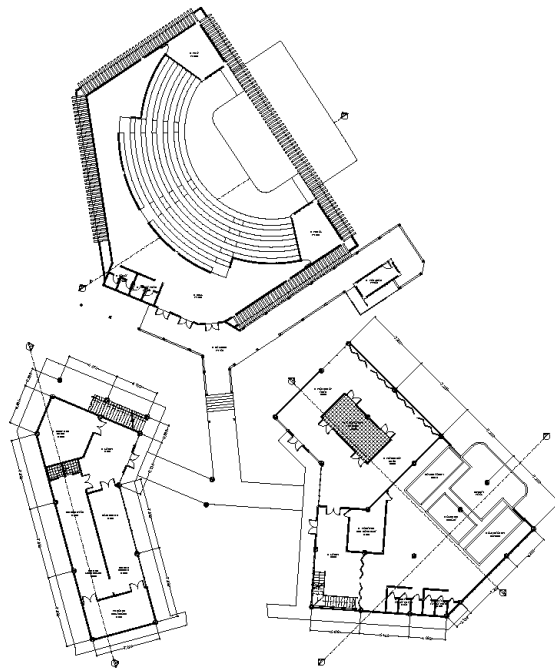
Site Plan *Blue Lagoon Water Cultural Center
